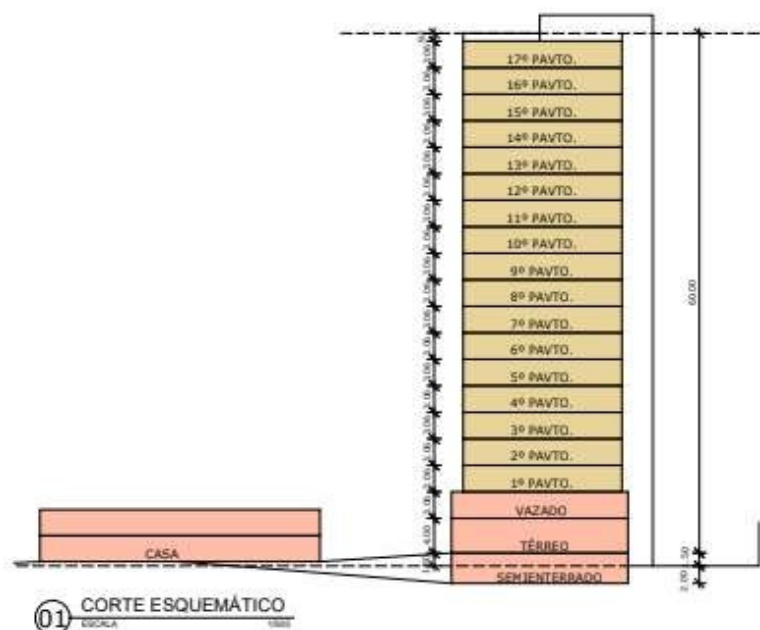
Corte esquemático Fonte: Projeto de arquitetura apresentado.
